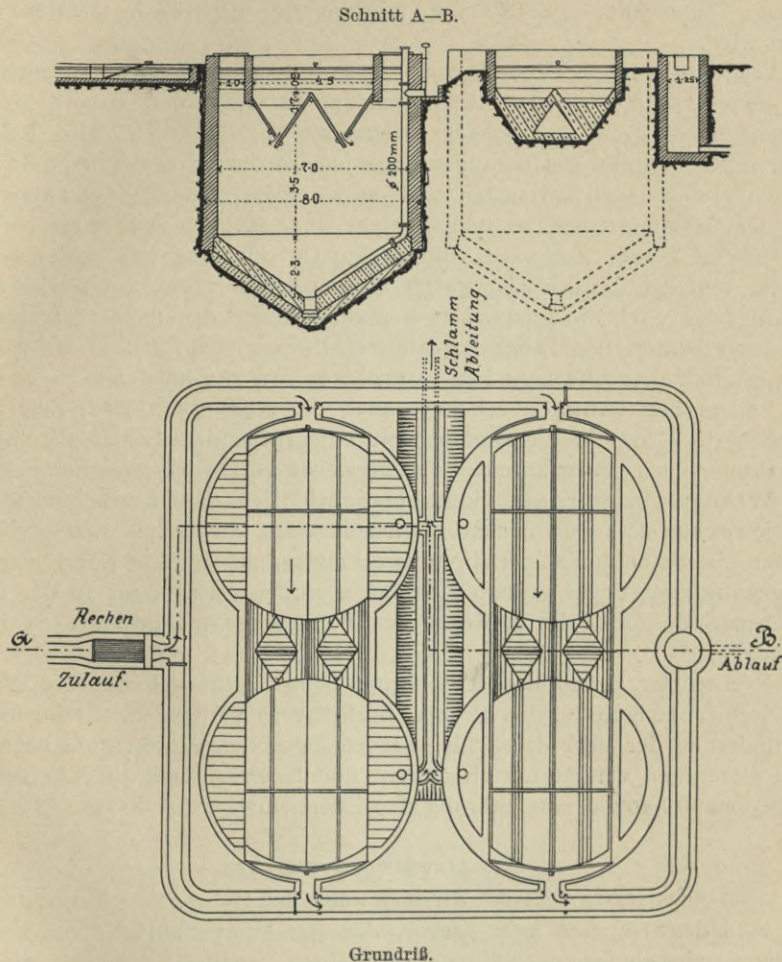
Kläranlage mit Schlammfau brunnen. Type der Emscher Genossenschaft.
